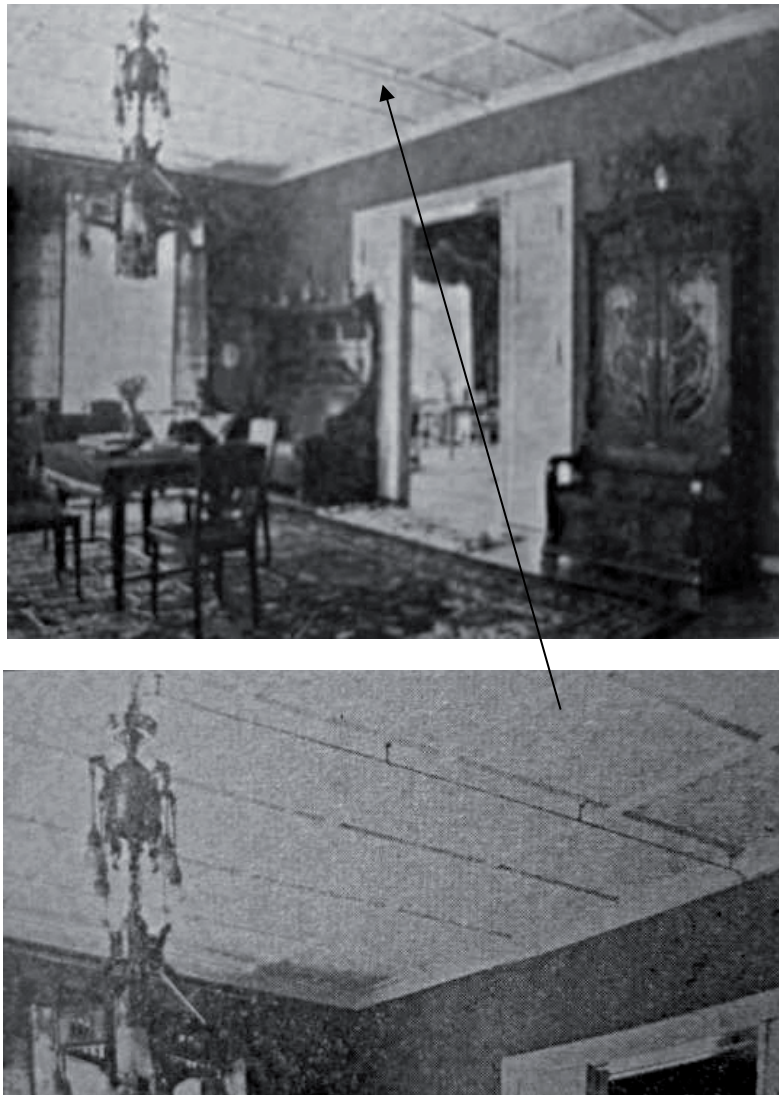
Rohrdrachtinstallation von den SIEMENS-SCHUCKERTWERKEN in einem Herrenzimmer
